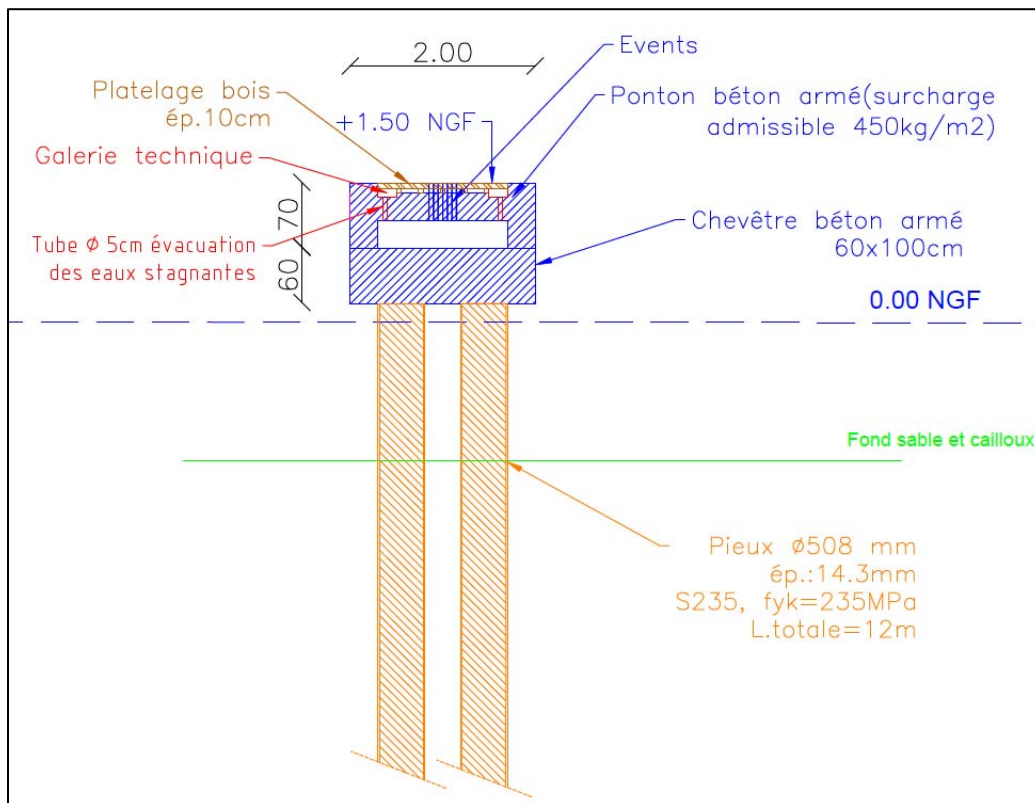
Nartelle centre – Aménagement appontement sur pieux – Coupe type transversale première partie du ponton (côté plage – P9)
